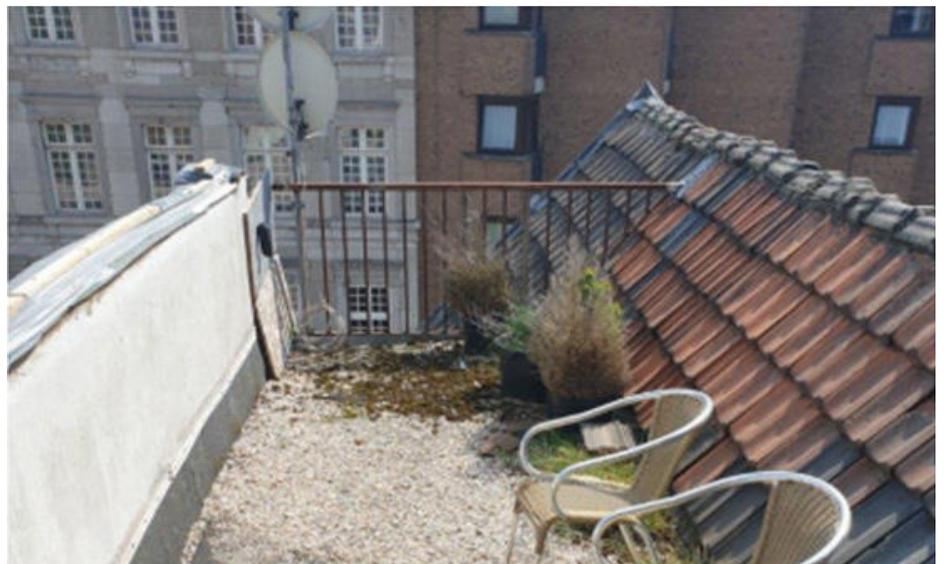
First Büchel 41 mit ergänzter Dachterrasse [Foto: SEGA]
